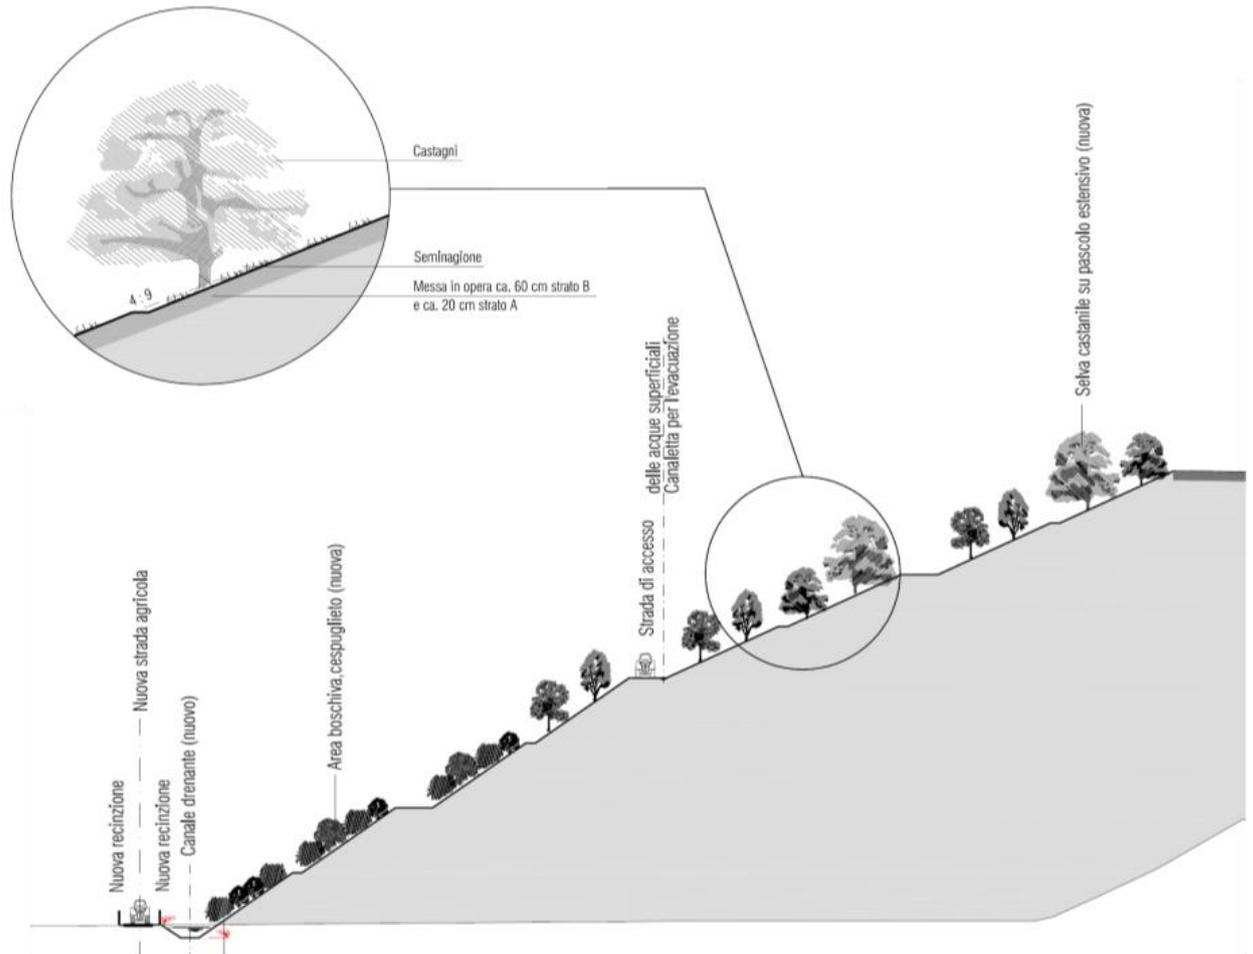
Sistemazione finale deposito ATG, pianta e sezione – rif. doc: 990/L609-203
